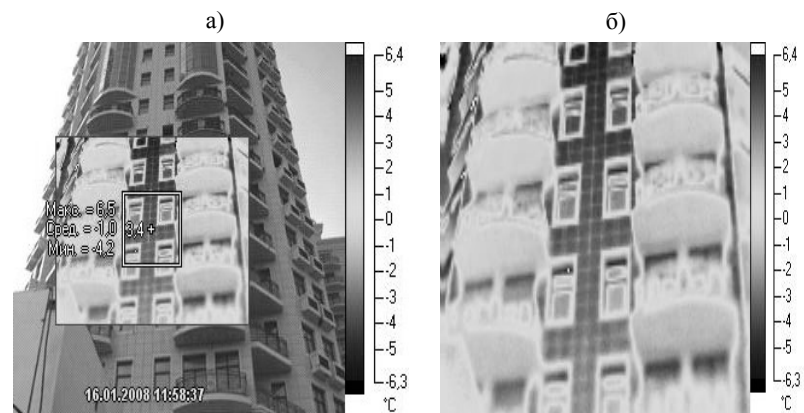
Жилое здание, утепленное вентилируемым фасадом:
